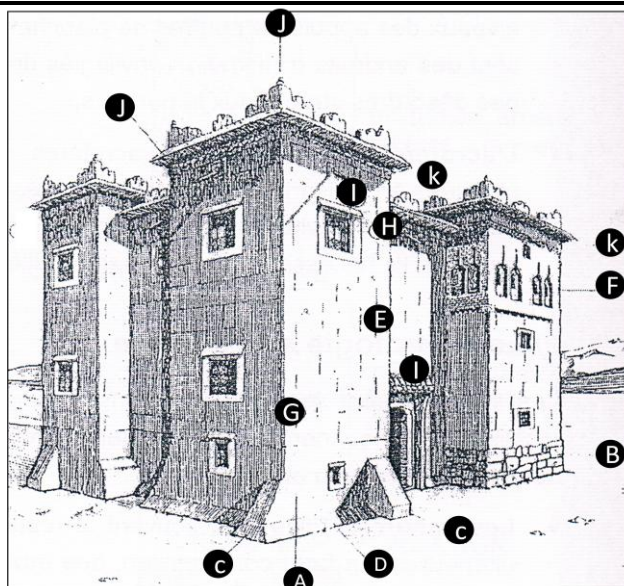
Le schéma de bonne conception architecturale d'un bâtiment en terre.
